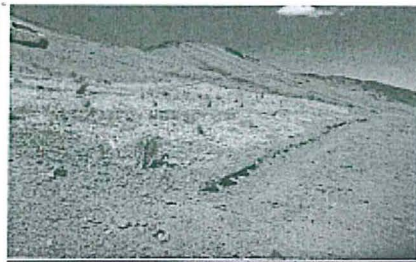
Vista Mirando hacia el Sureste (revegetación).
